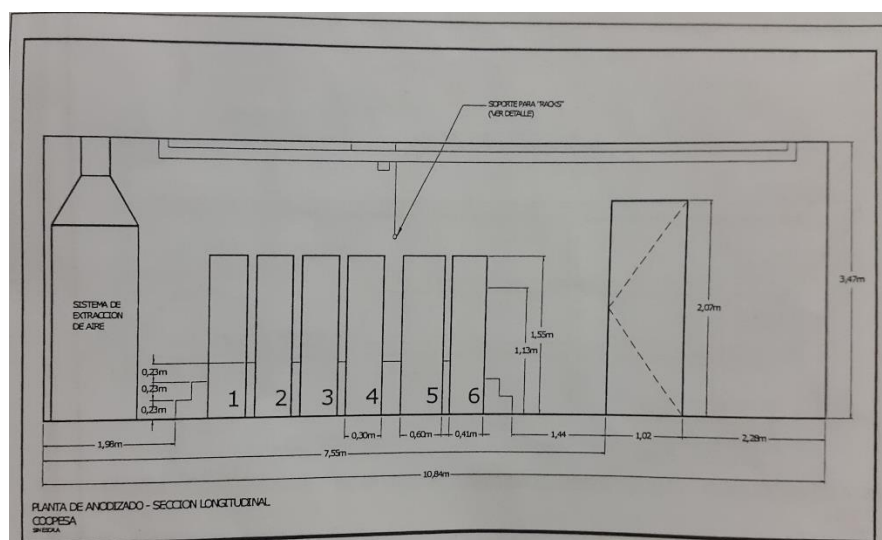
Planta de Anodizado - Sección Longitudinal Coopesa
